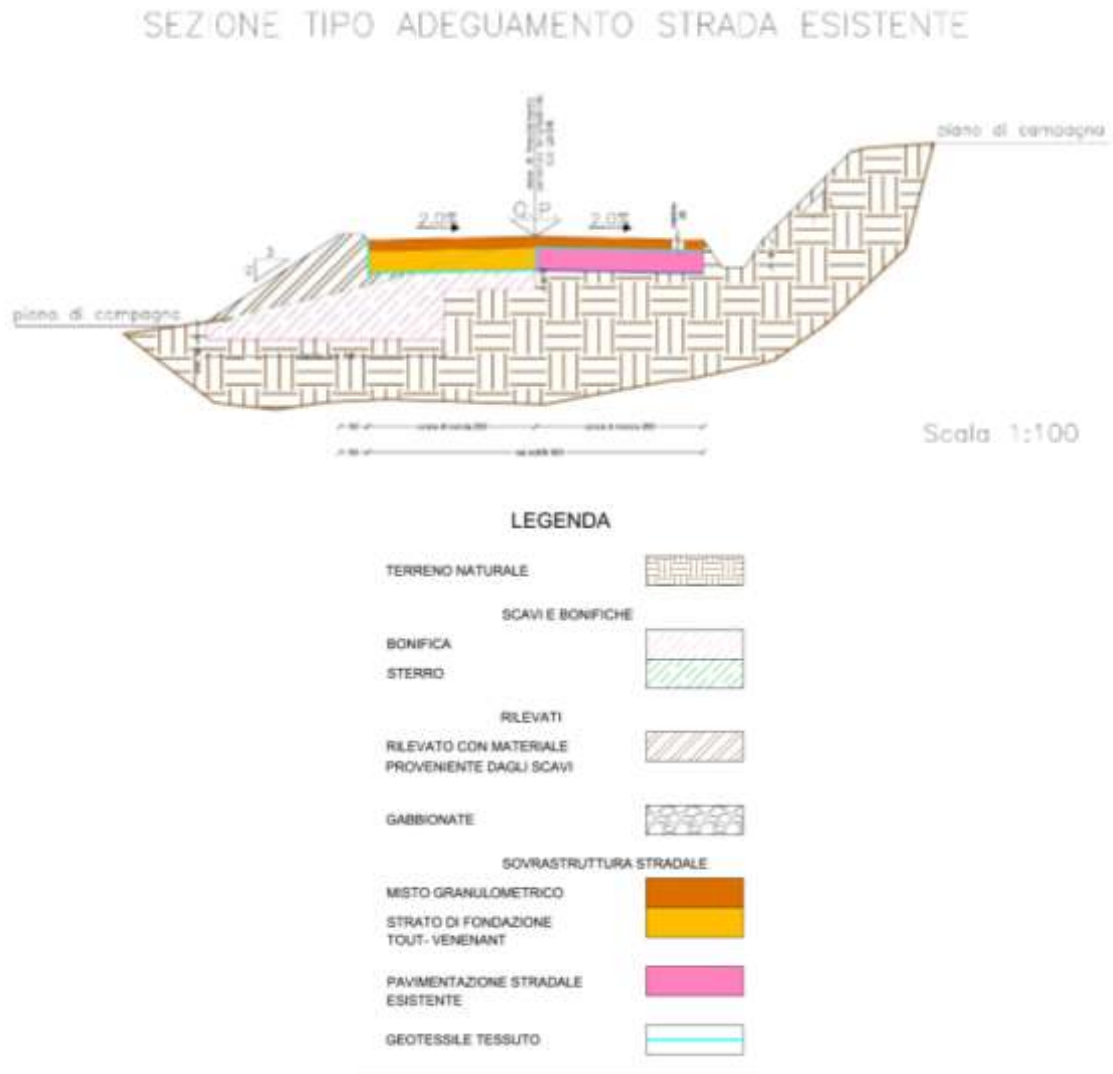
Sezione tipo adeguamento strada esistente
